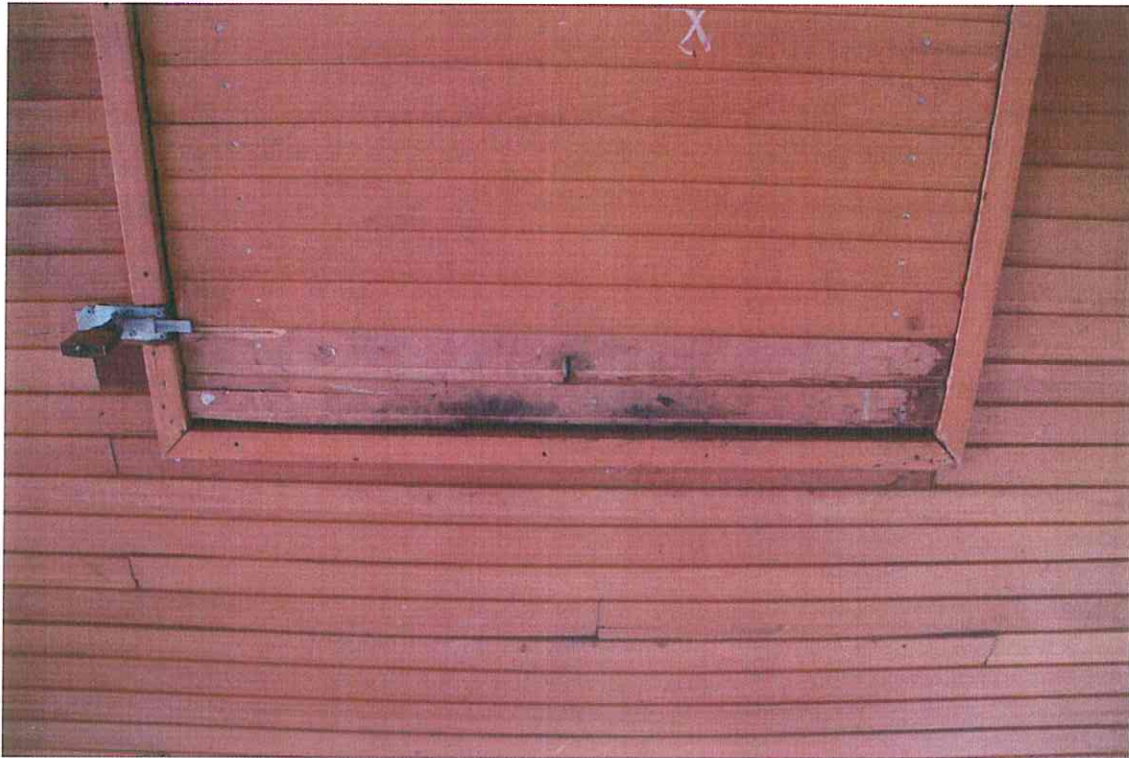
Wasserschaden Klappe Ausstieg aufs Dach
